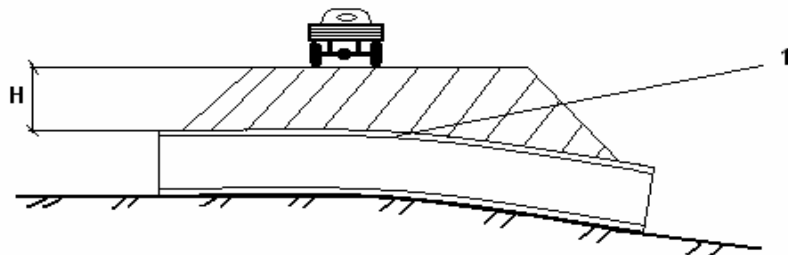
П2. Схема строительного уклона (строительный уклон  $i = 1/50H$ ), где  $H$  – высота насыпи
